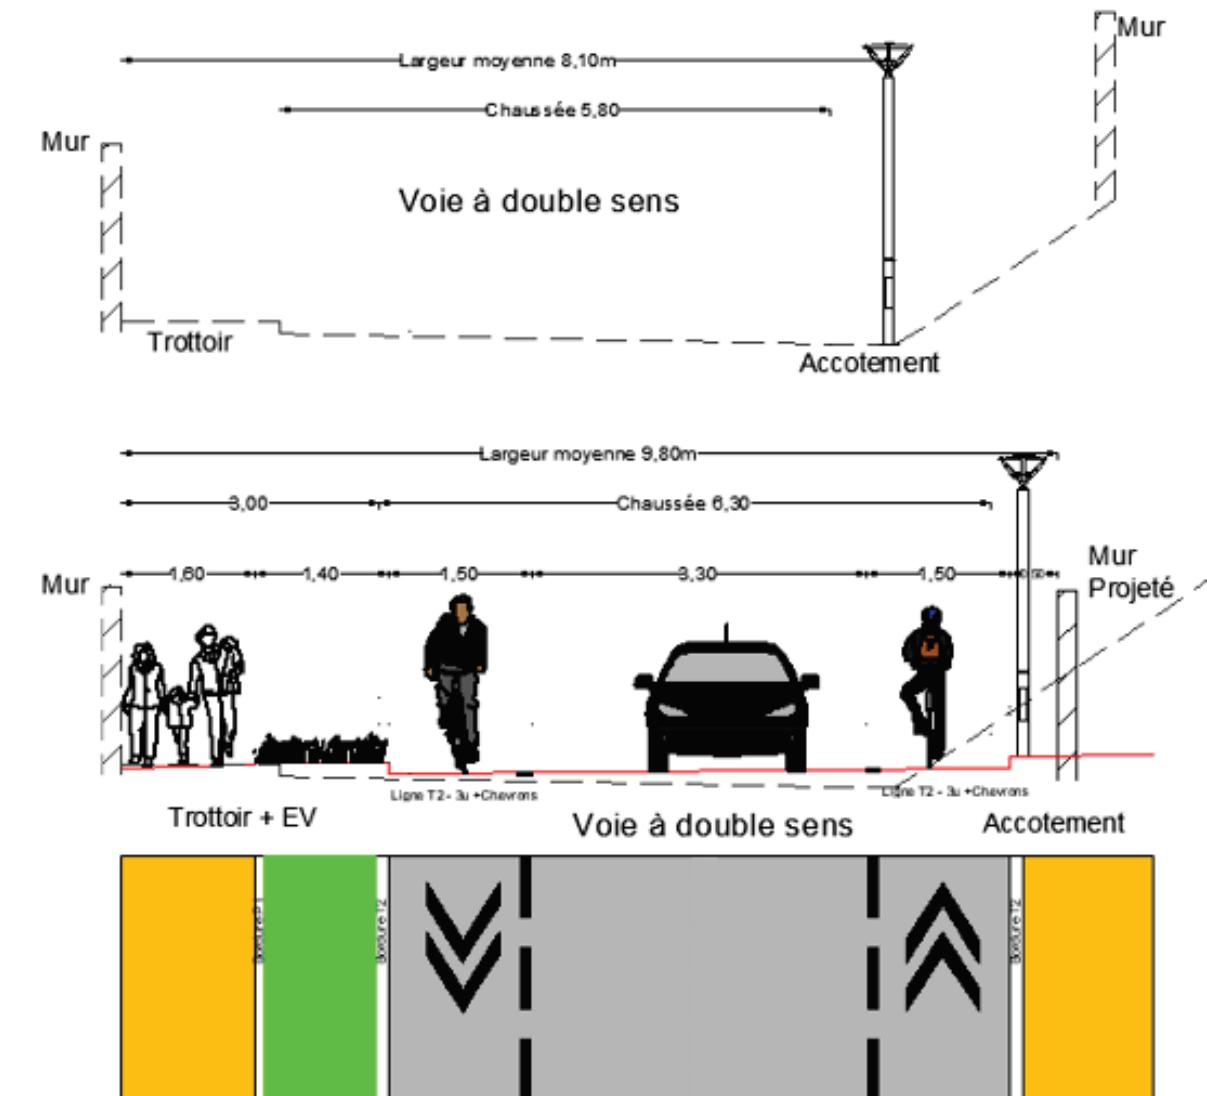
Vue en coupe de la chaussée à voie centrale banalisée au nord du chemin des Vignes
